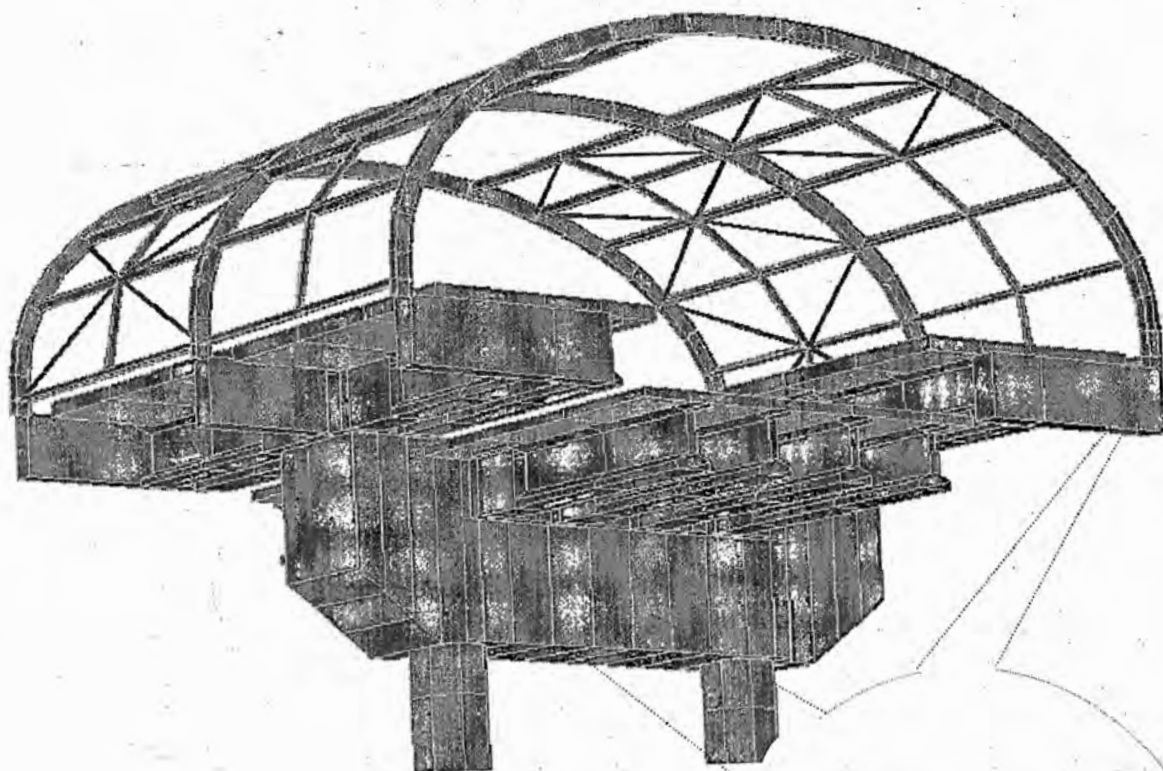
Conexión de estructura metálica de acero con superestructura de hormigón (Fuente: SAP 2000)
